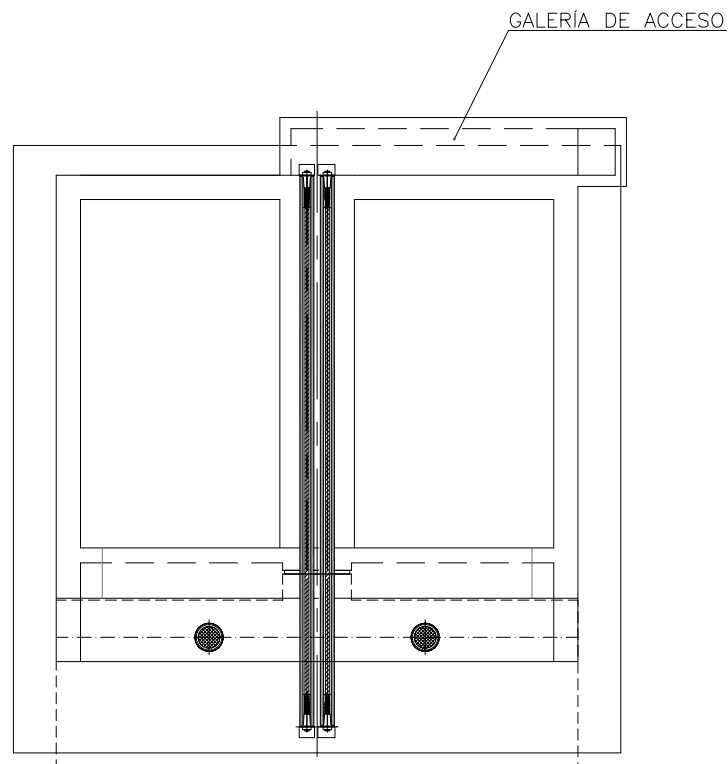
Estribo fijo de tablero tipo cajón de hormigón pretensado. Sección horizontal
